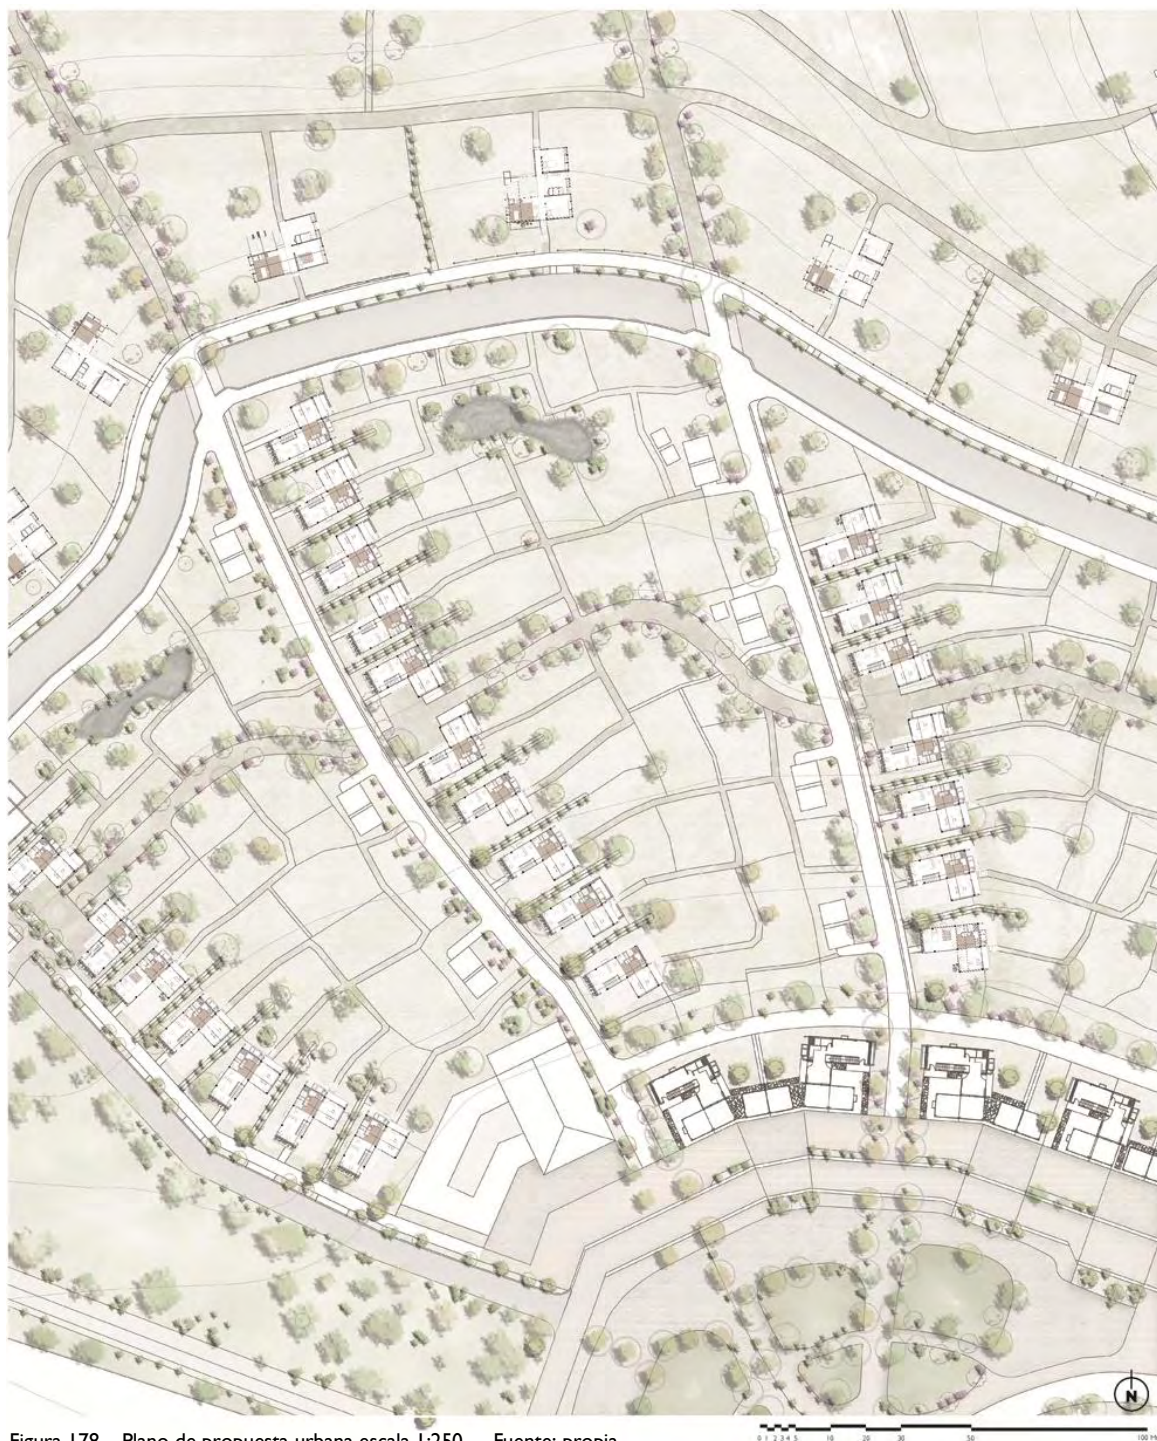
Plano de propuesta urbana escala 1:250 Fuente: propia
